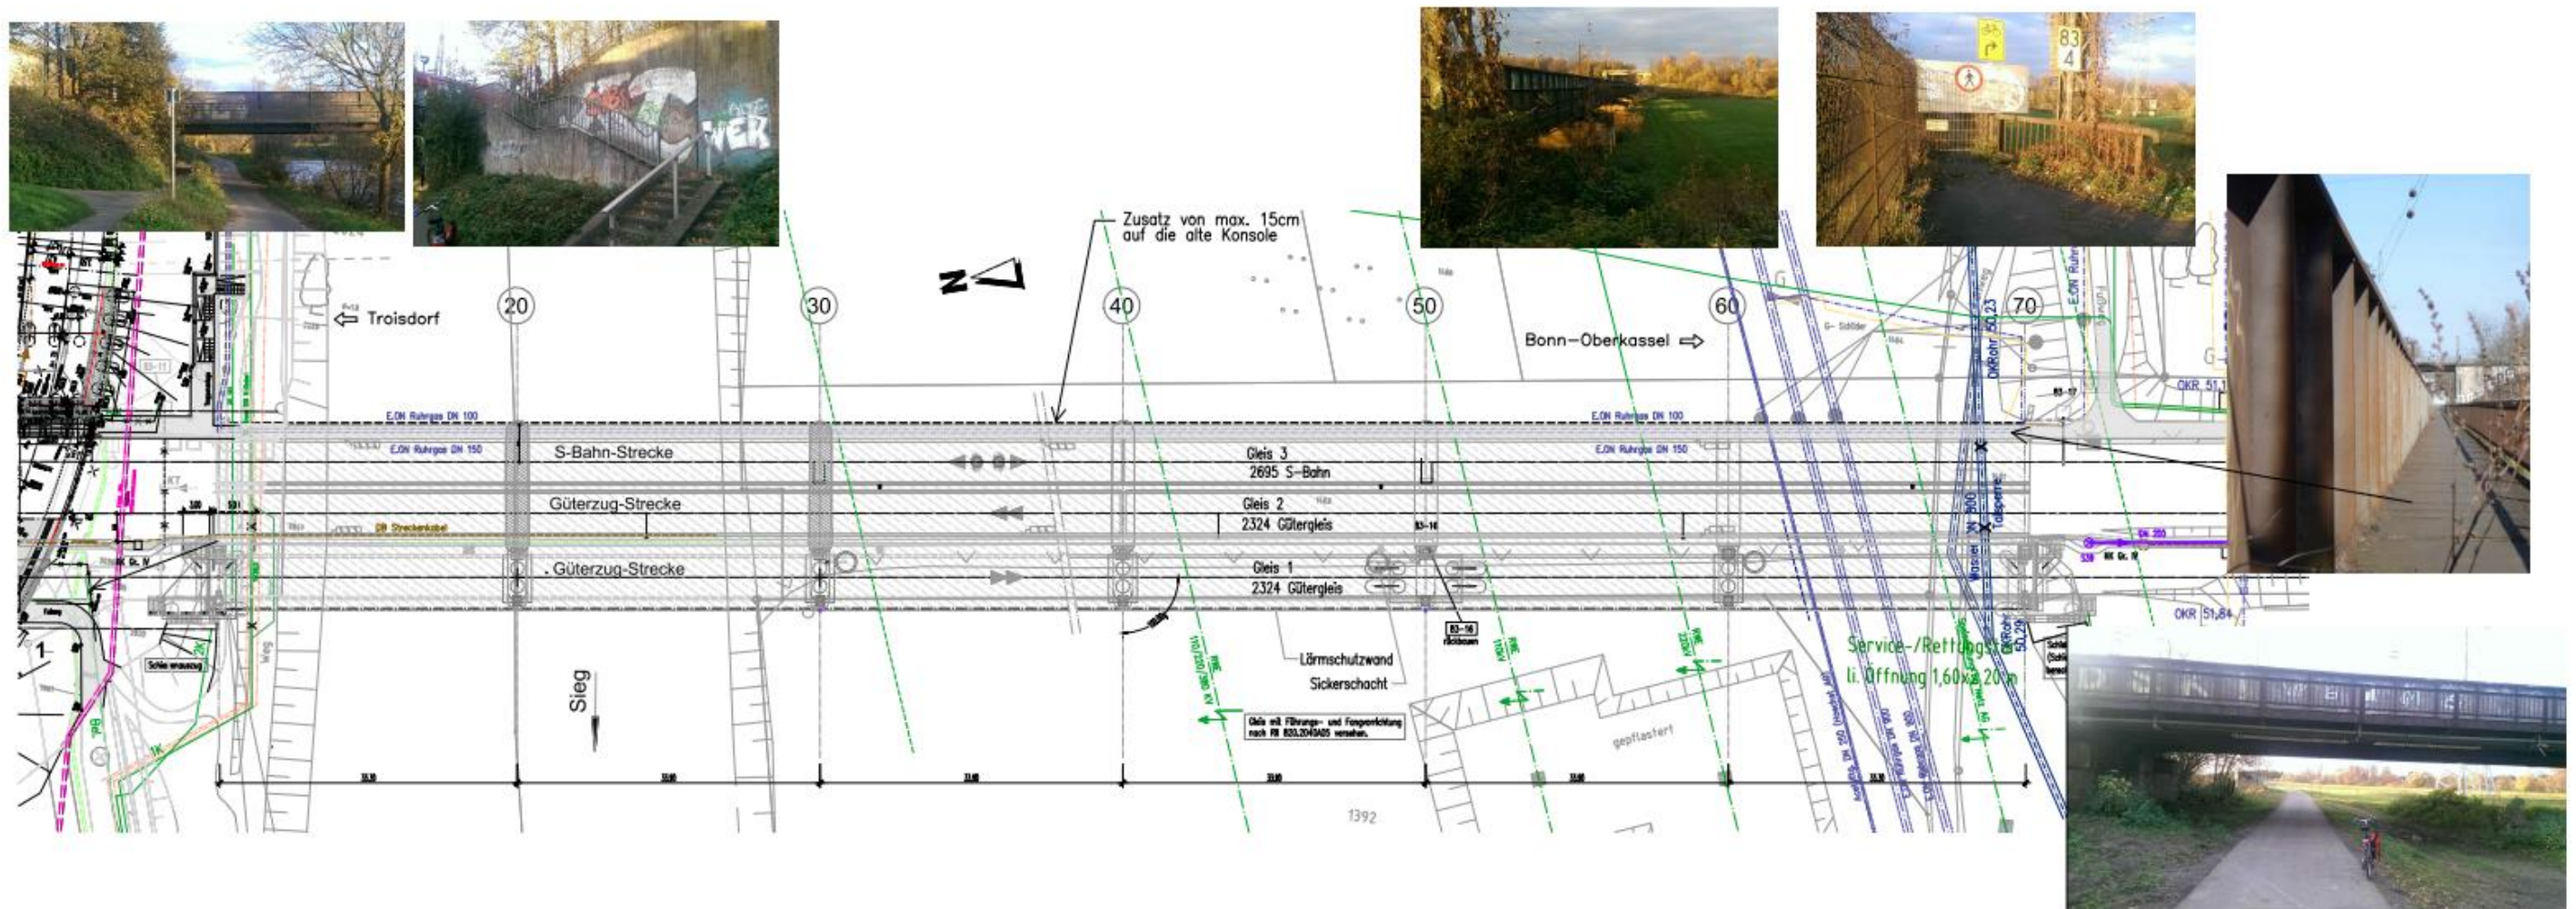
Grundriss_Variante IIb - Ostseite
